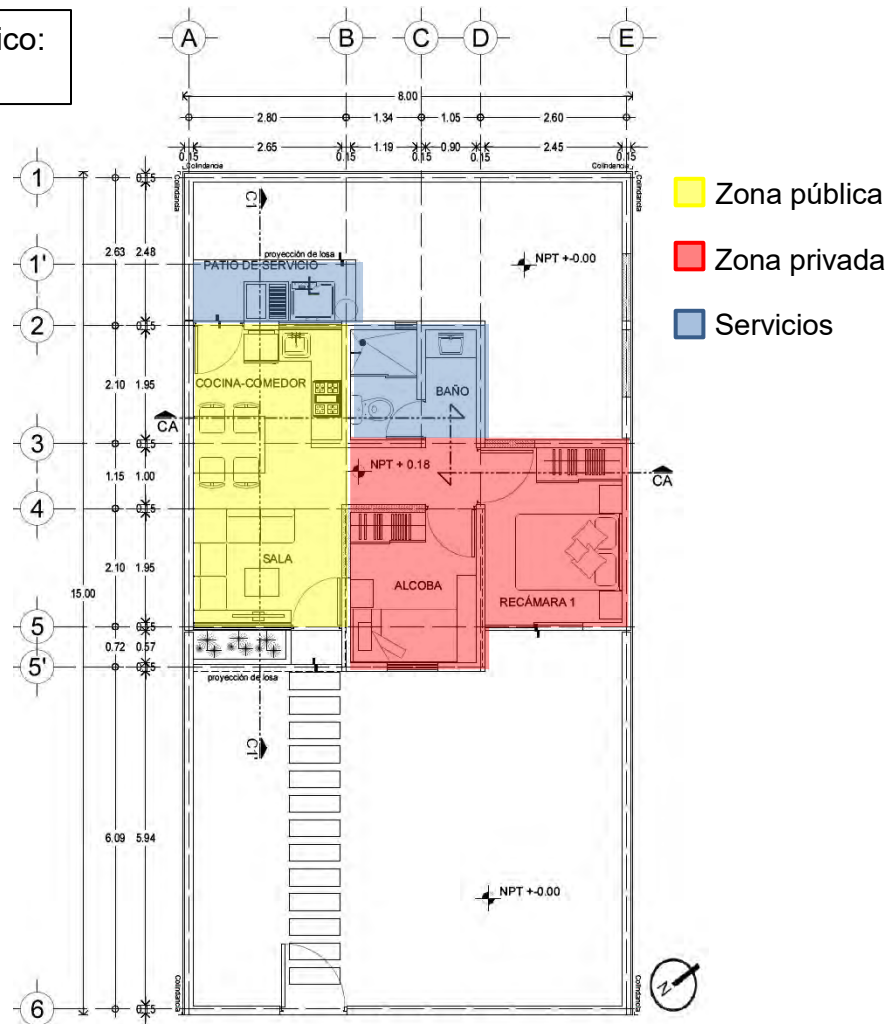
Planta arquitectónica de prototipo de vivienda A3. Primera etapa.
